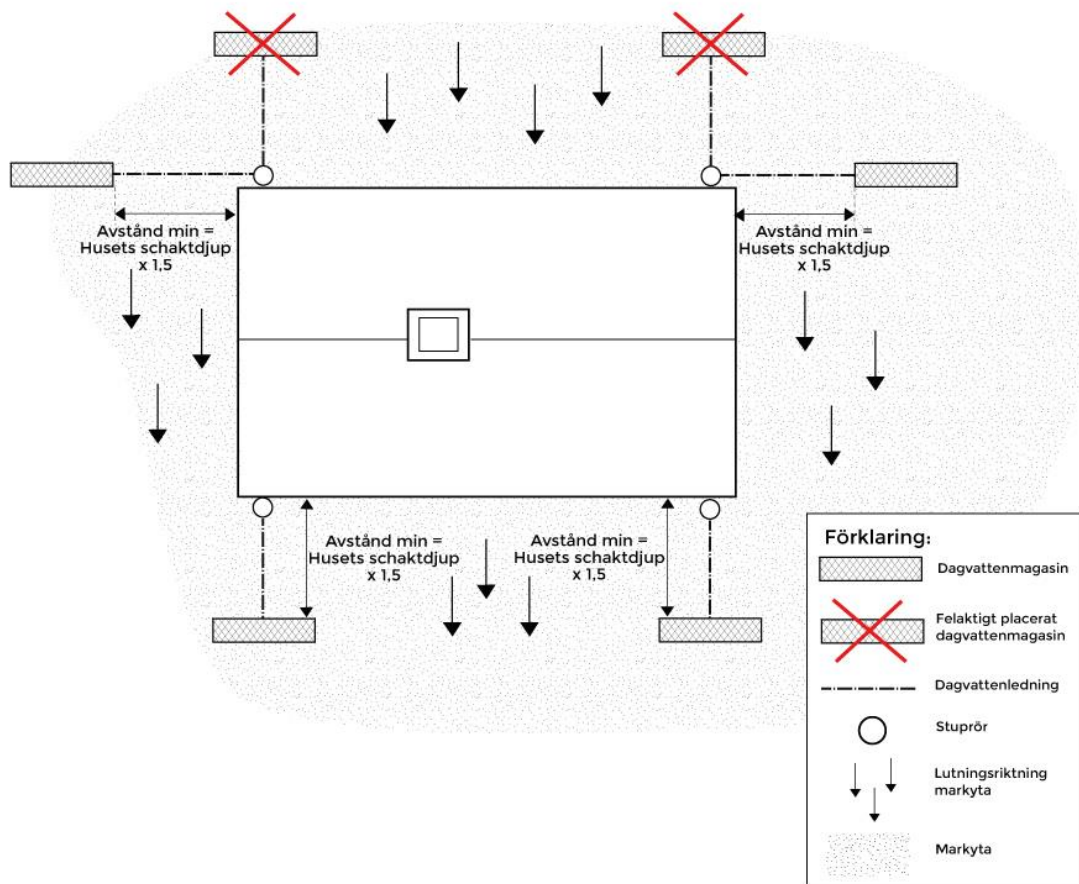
Placering dagvattenmagasin plan mark alternativ 1.
